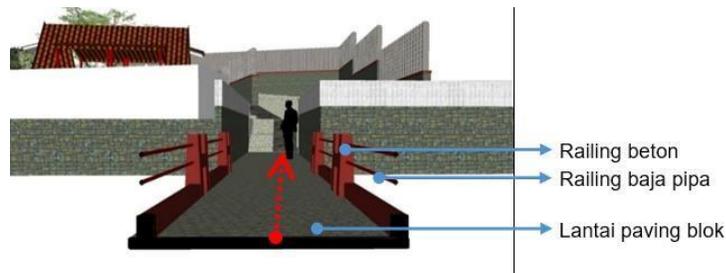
Elemen Penyusun Ruang pada Jalan Masuk
